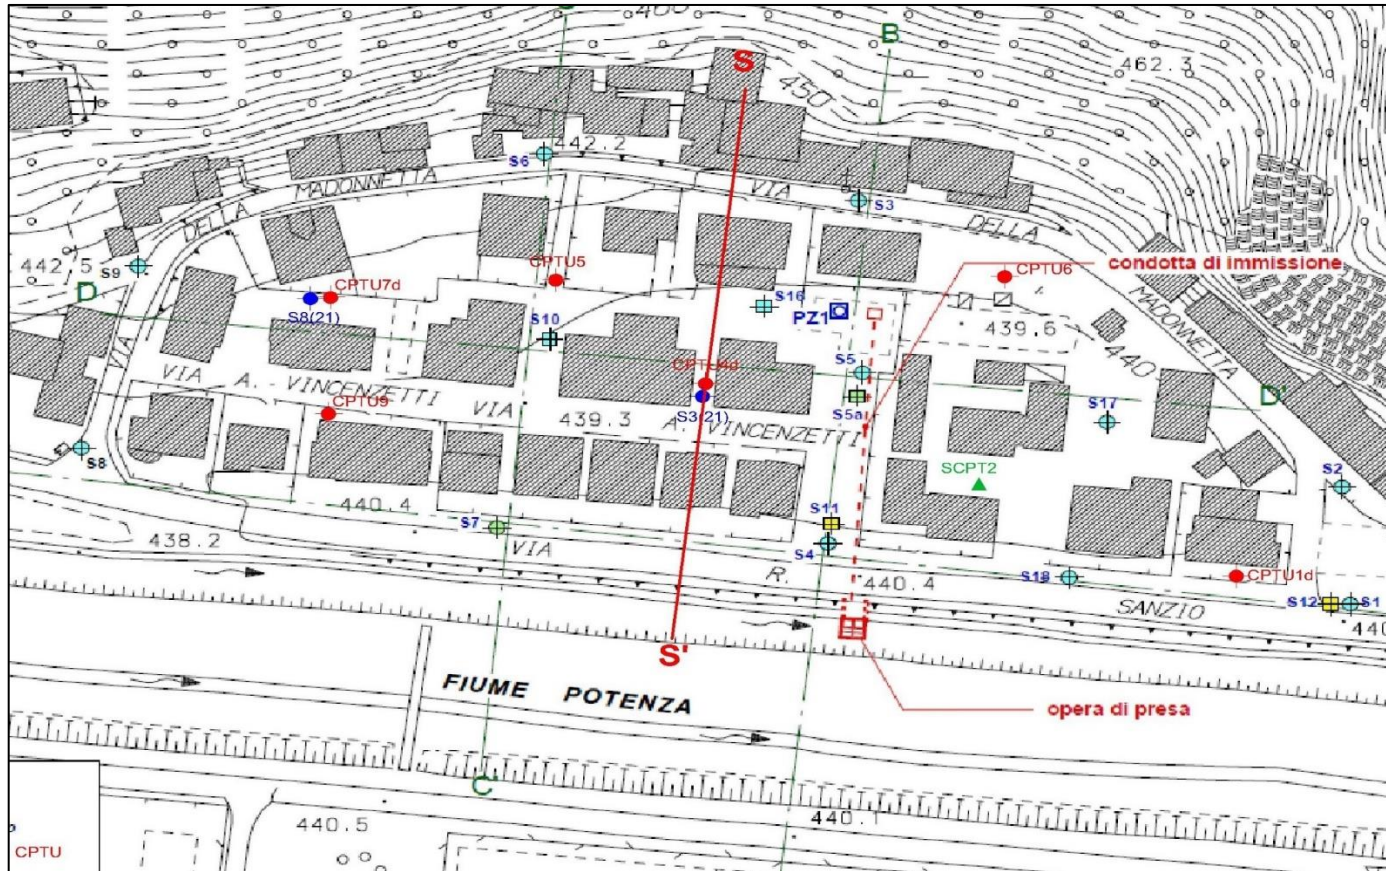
Rappresentazione sezione S-S' in planimetria
